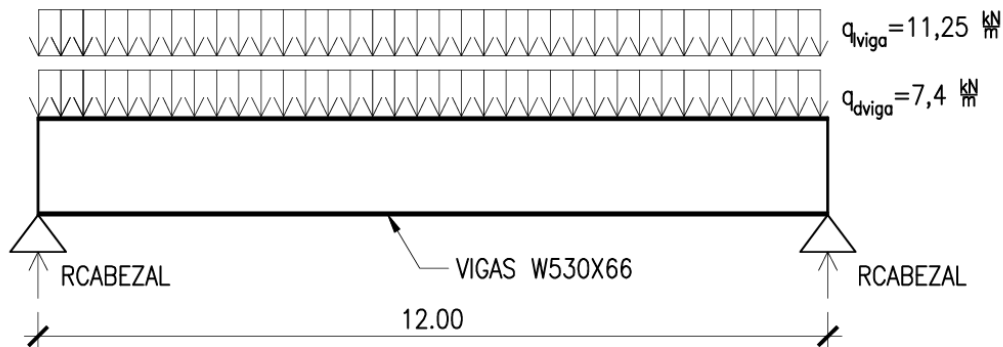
Cargas D y L sobre las vigas metálicas.
